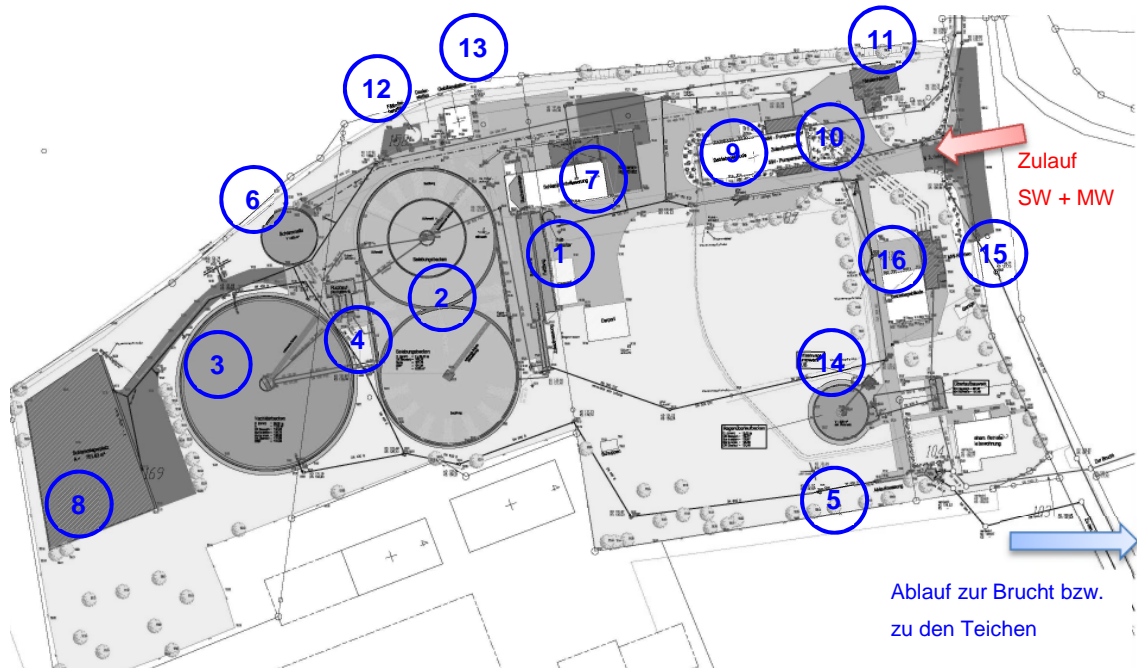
Lageplan Kläranlage Brakeler Märsch (Plangrundlage: Ing.-Büro Turk, 2012)
